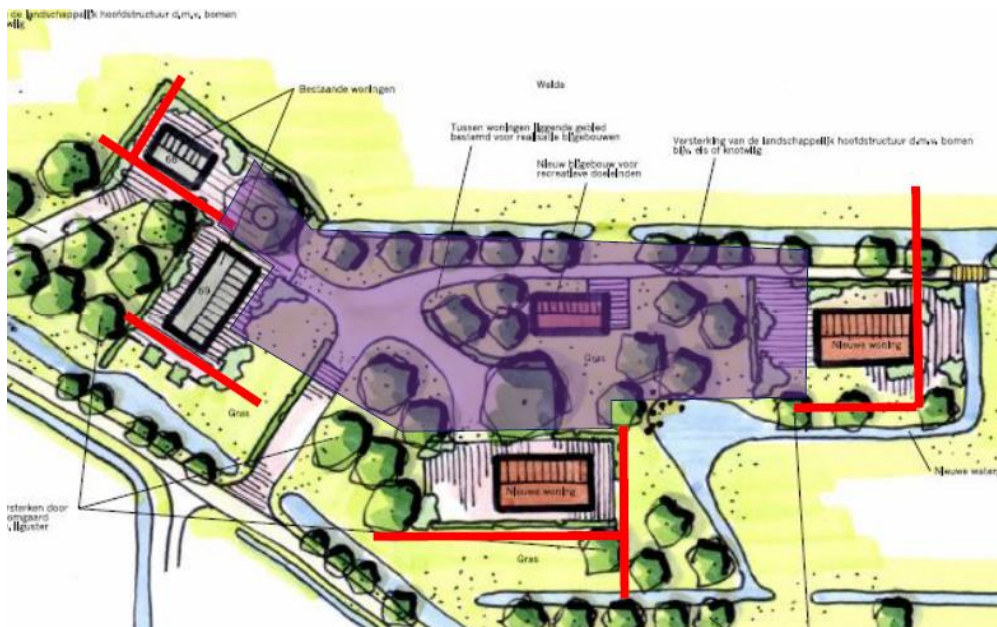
Grote bebouwingsensembles met open ruimten ertussen
